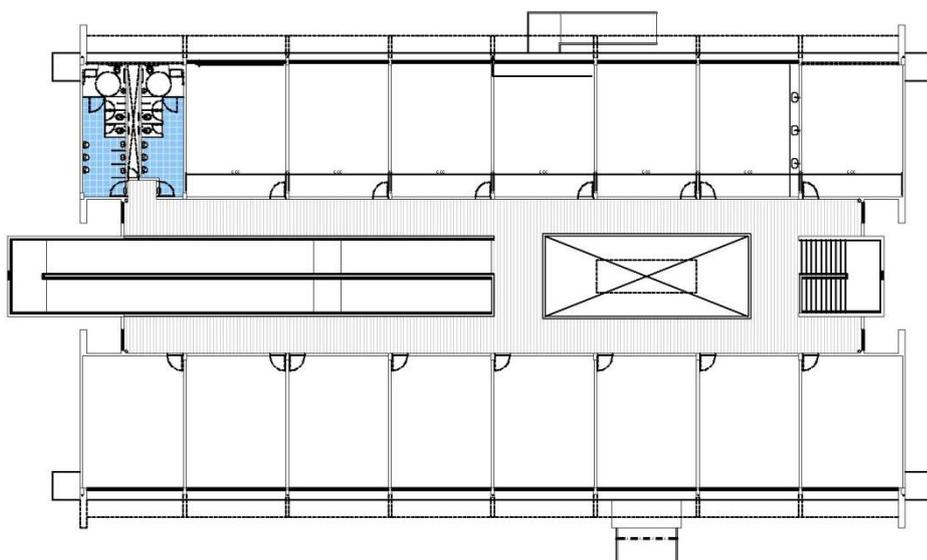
Planta Baixa 1º Pavimento - Escola Modelo-Padrão de João Pessoa - PB.
